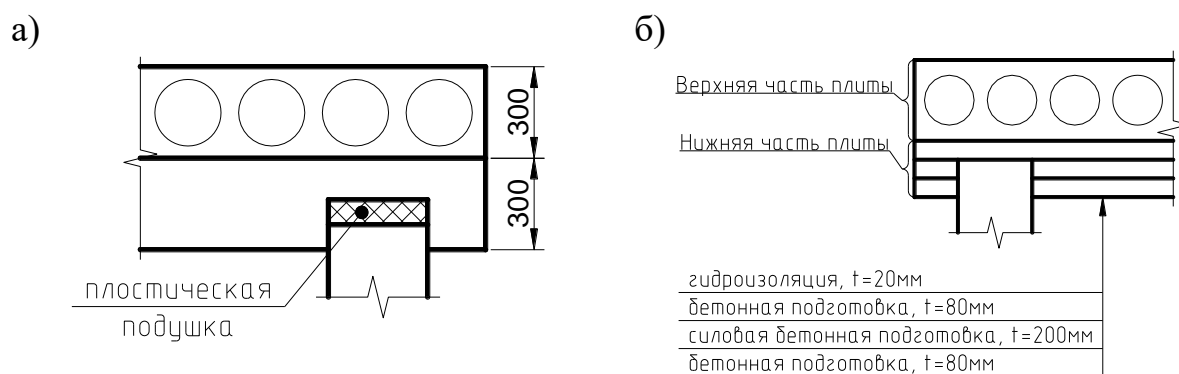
Конструктивные схемы плитно-свайных фундаментов с пластической (а) и силовой бетонной подготовкой (б)
